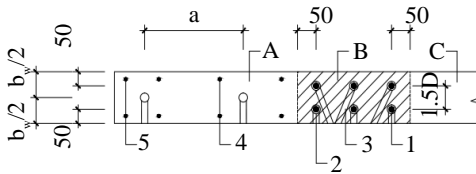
预制墙板内钢筋连接套筒布置示意
